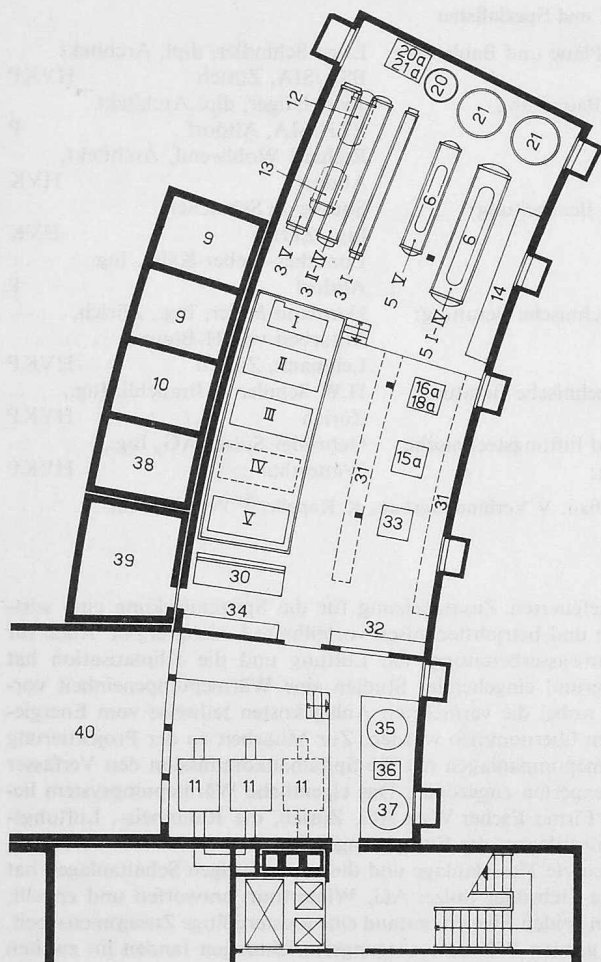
(links). Grundriss des Kellergeschosses im Verbindungstrakt mit Wärmepumpanlage und Heizkessel für Zentralheizung
